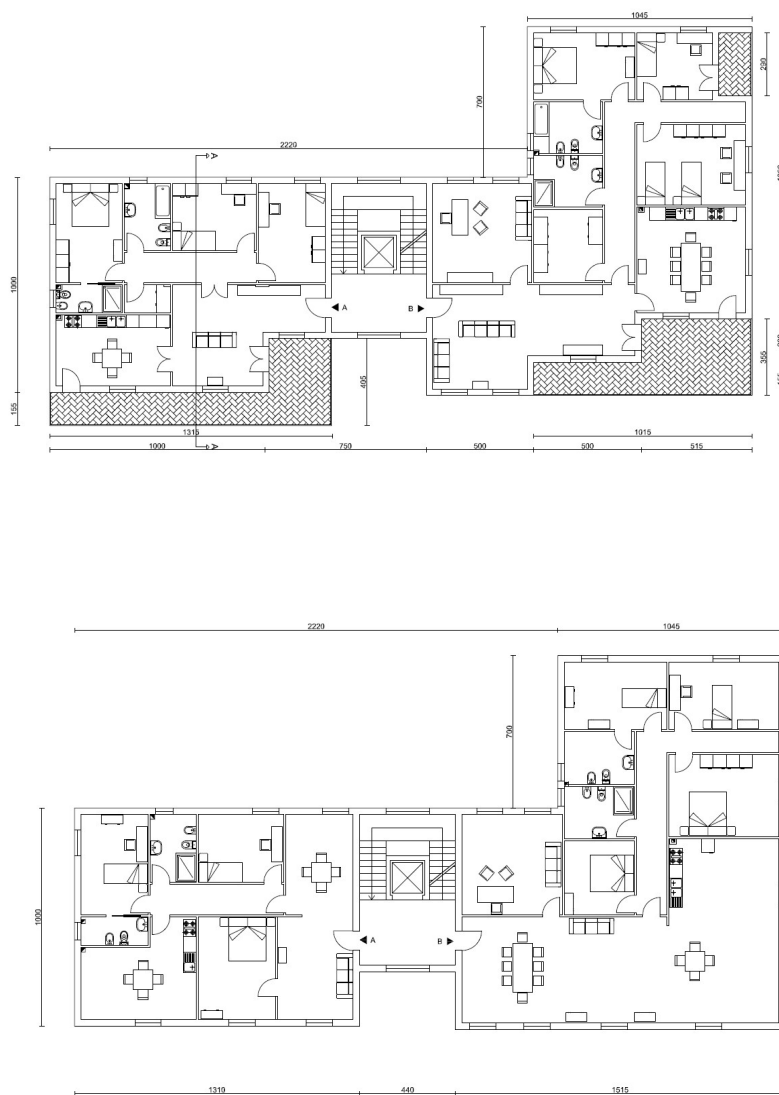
Pianta del piano tipo (sopra) e Pianta della mansarda (sotto)
